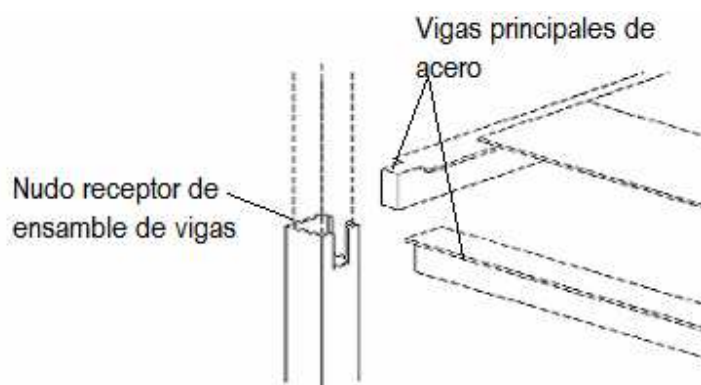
Ensamblaje de elementos lineales de acero. Esquema general. Pilar con armaduras salientes, vigas con ala superior para apoyo de losa.
